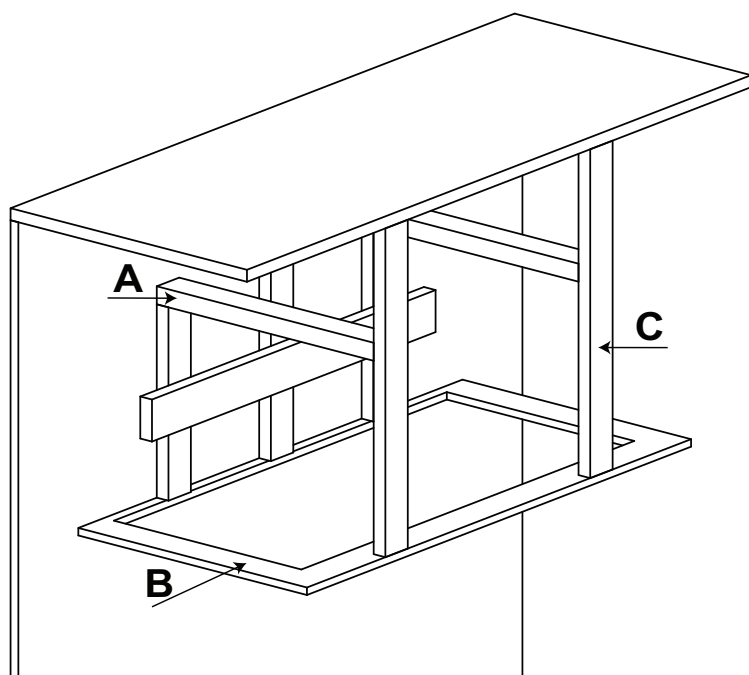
Dimensions des montants arrière pour les modèles VCIB
